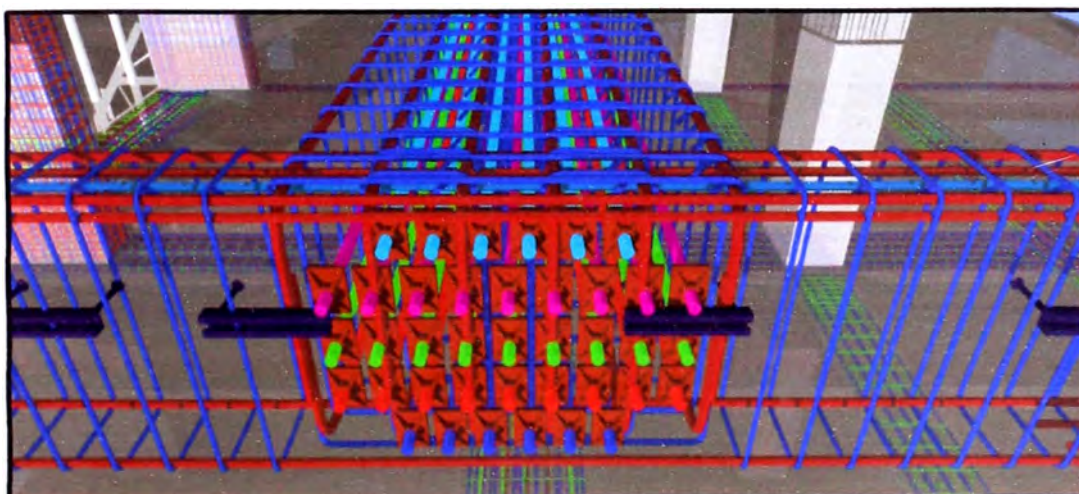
38: Modelado del Acero de Refuerzo y anclajes de muro cortina para evitar interferencias
